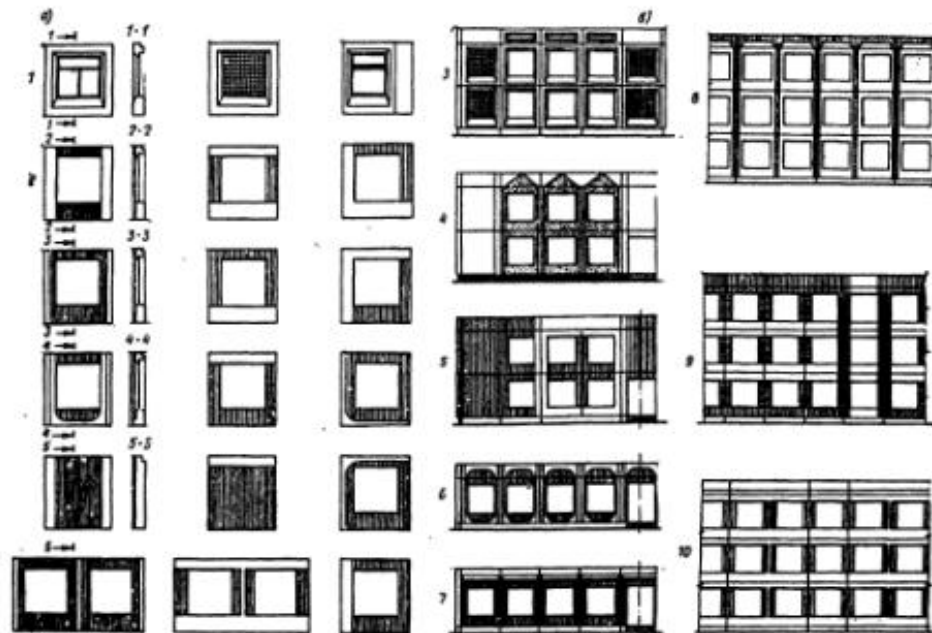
Примеры фасадной отделки панелей наружных стен и схемы фрагментов фасадов панельных общественных зданий: а - панели; б - схемы фасадов; 1 - панели кессоны по Единому каталогу для Москвы; 2 - панели, сочетающие два типа фактуры или рельефа; 3 - 5 - схемы фасадов двухэтажных зданий; 6 и 7 - то же, одноэтажных; 8 - 10 - то же, трехэтажных
